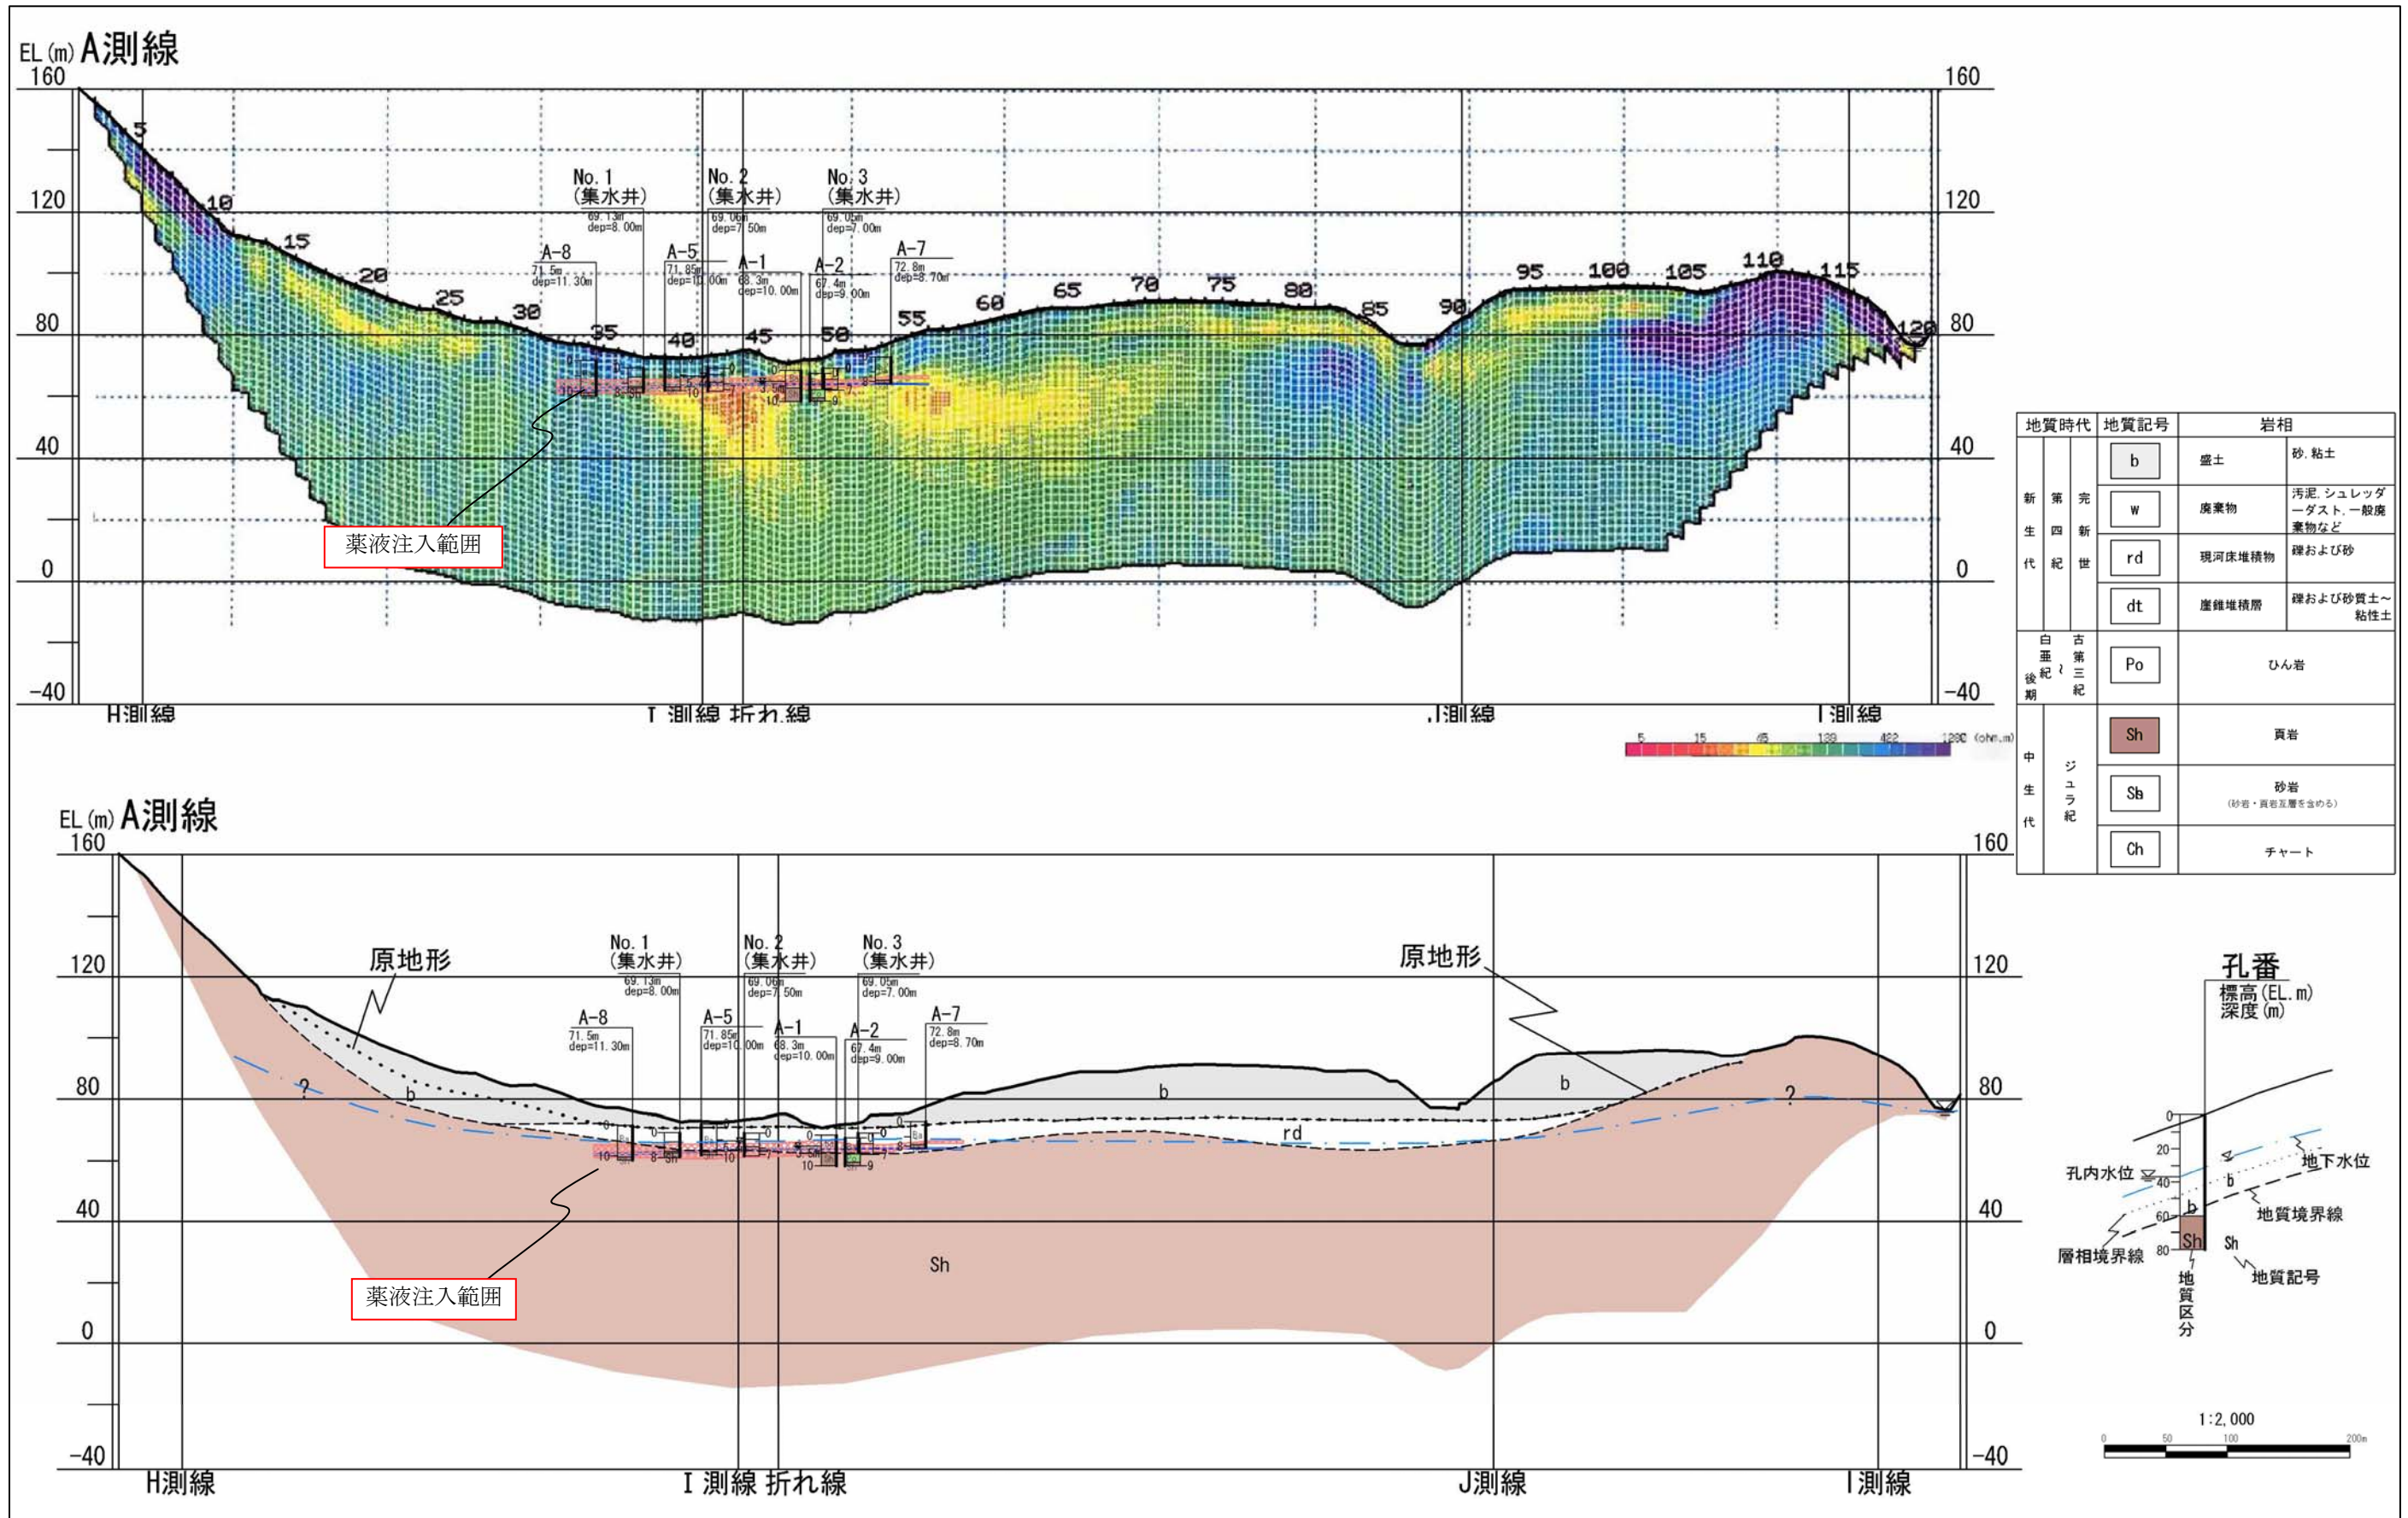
A測線沿い地質断面図 (S=1:2,000)
